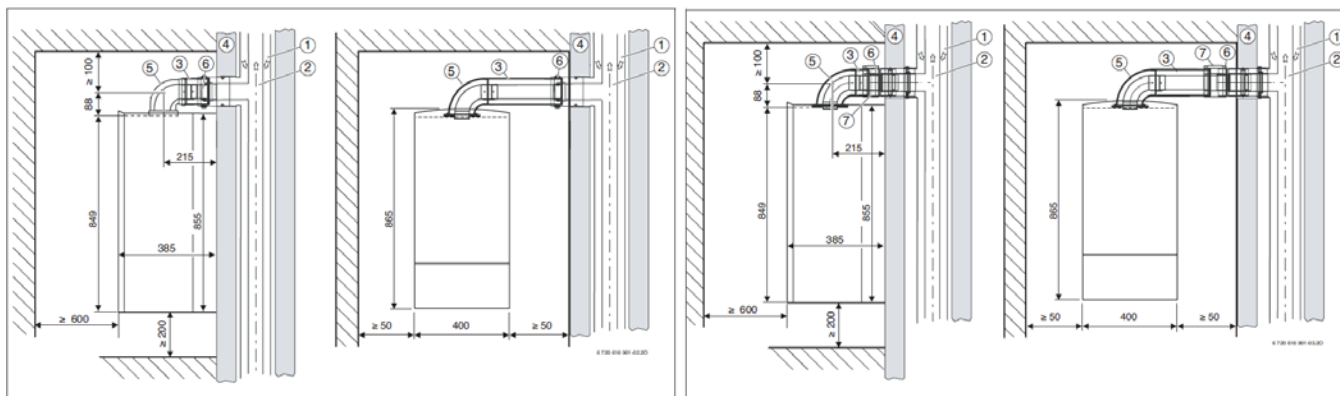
Conduits concentriques horizontaux 3CE type C42 (Poujolat)
